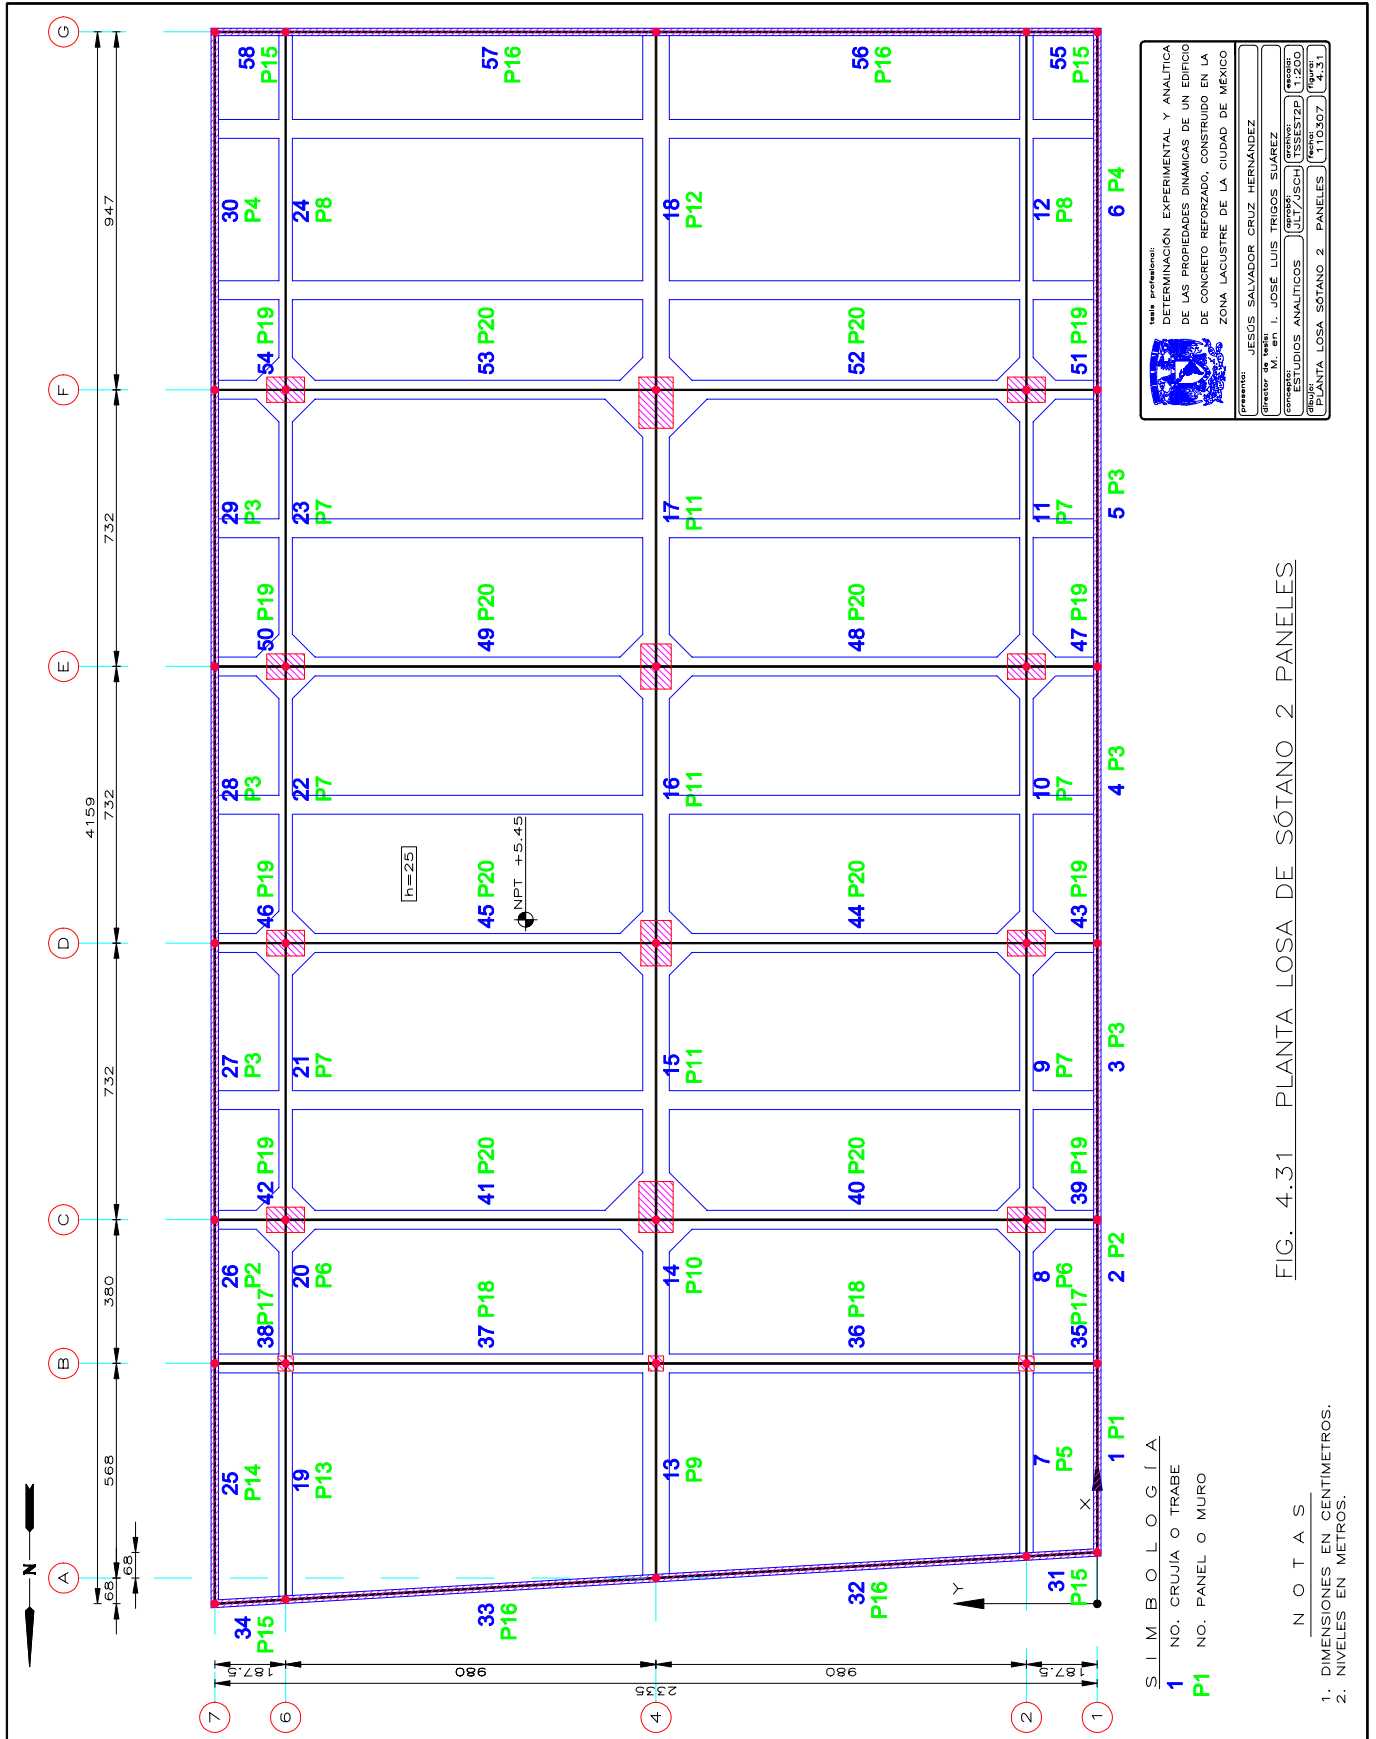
PLANTA LOSA DE SÓTANO 2 PANELES
